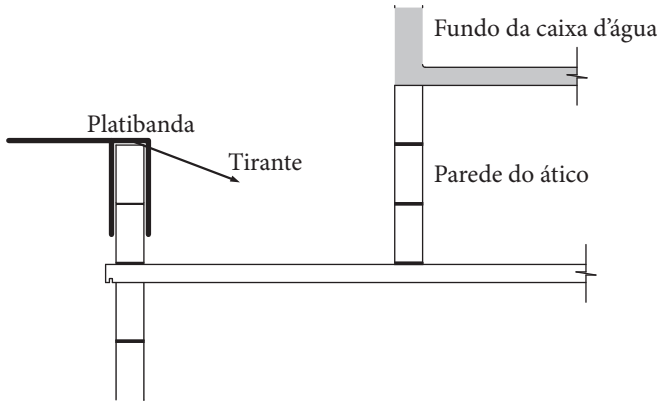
Balancim apoiado em tirantes ancorados na laje e/ou no ático.
